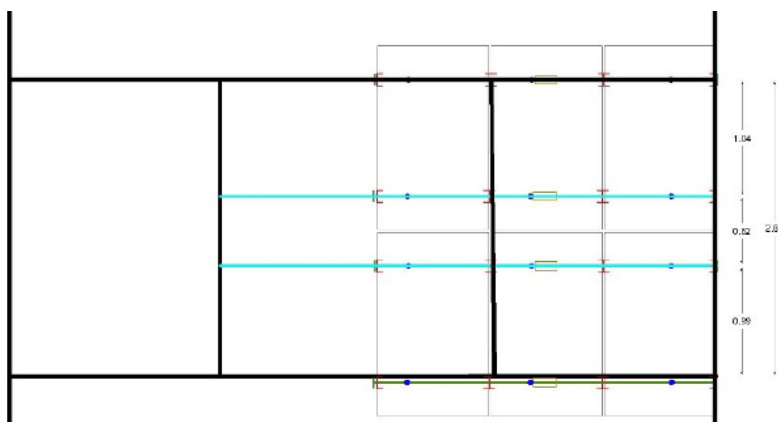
Plano de la estructura metálica de soporte de la instalación de 1.59kWp.
